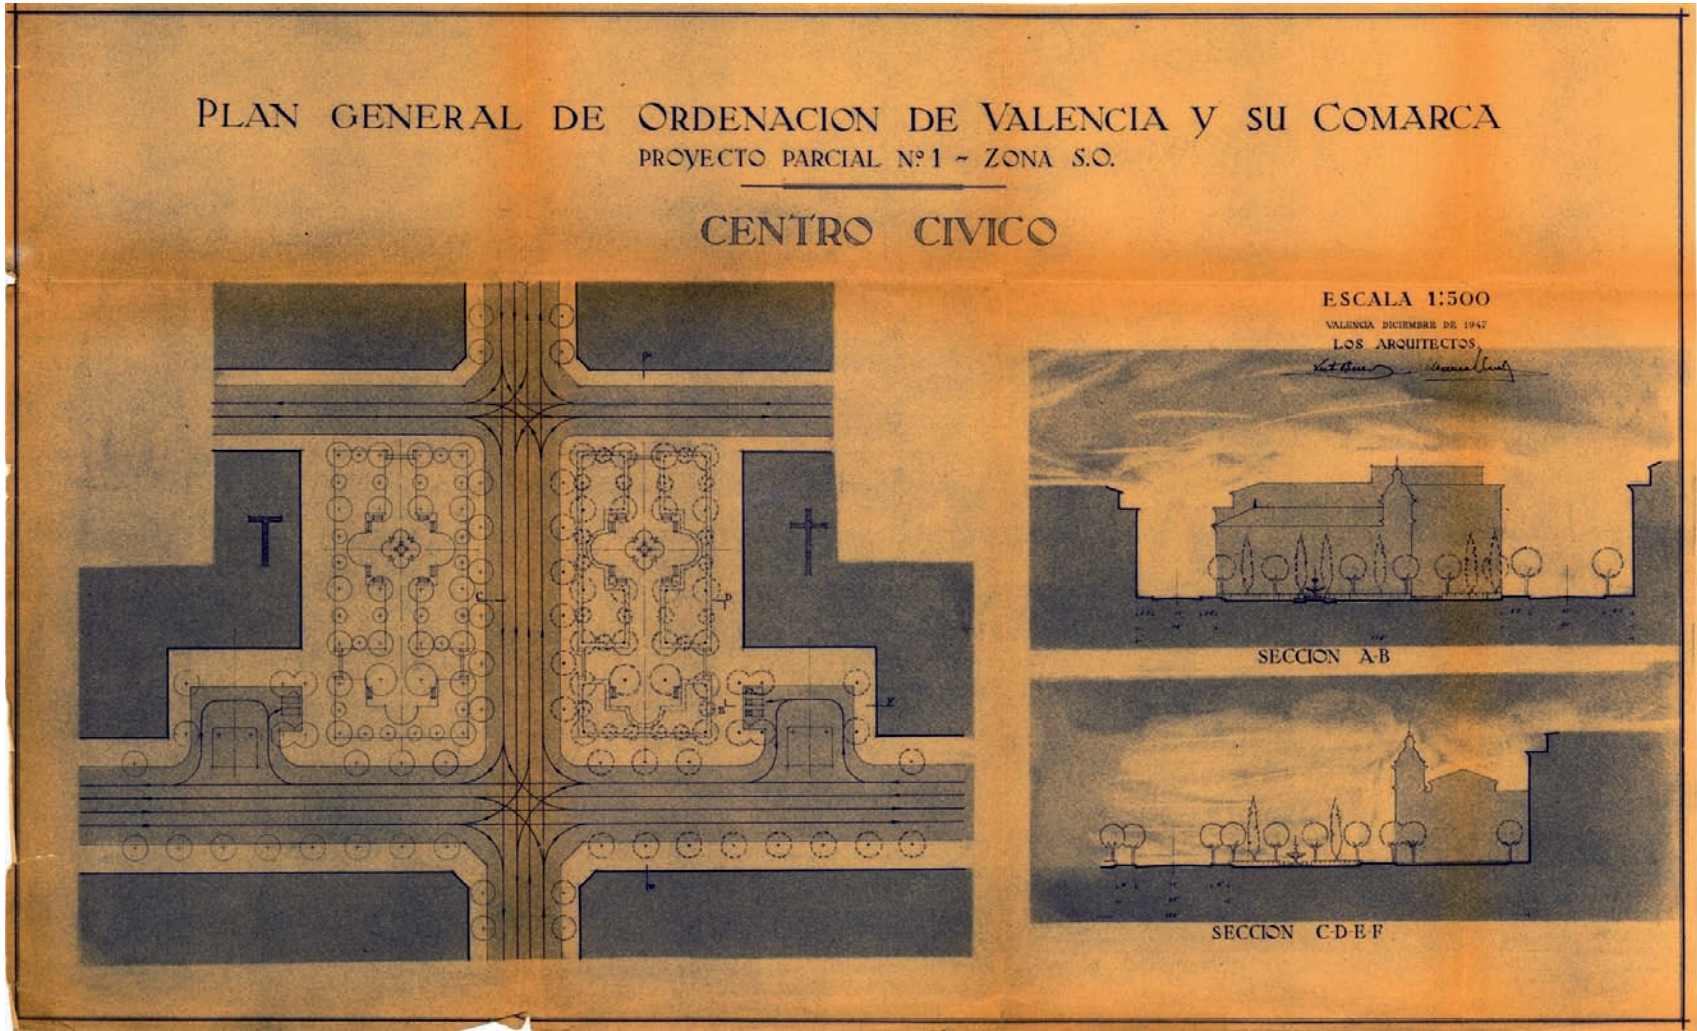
Centro cívico. Escala 1:500. Firmado. Diciembre 1947. Previsto para la calle Tres Forques, en su intersección con Santa Cruz de Tenerife. Fuente: APAV.
